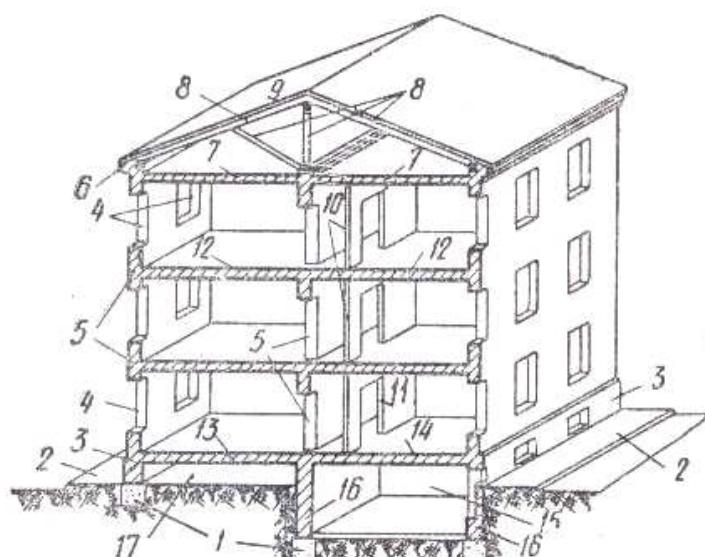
Конструктивные элементы малоэтажного гражданского здания высотой в три этажа. 1 – фундаменты, 2 – тротуар, 3 – цоколь, 4 – оконные проёмы, 5 – несущие стены, 6 – карниз, 7 – чердачное перекрытие, 8 – стропильная система, 9 – кровля, 10 – перегородки, 11 – дверные проёмы, 12 – междуэтажные перекрытия, 13 – перекрытие над подпольем, 14 – подвальное перекрытие, 15 – подвал, 16 – стены подвала, 17 – подполье
